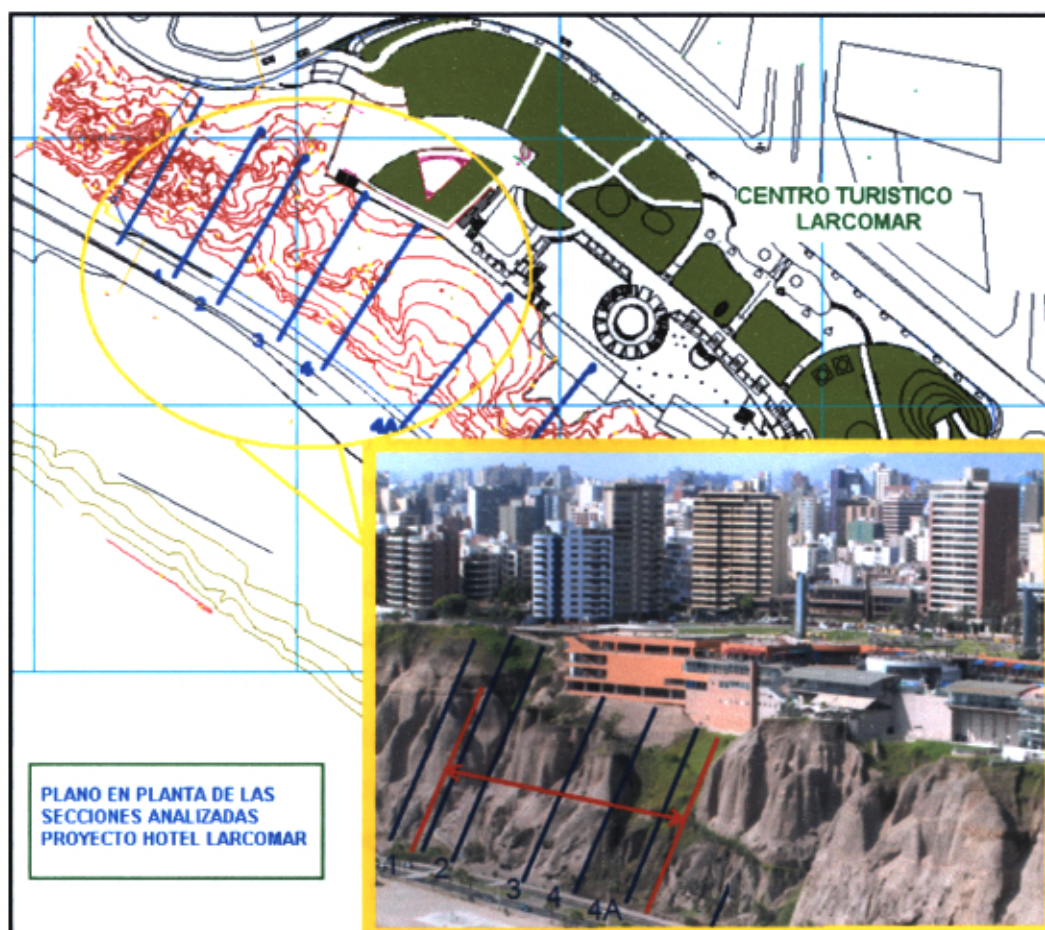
Vista en planta de secciones analizadas para la estabilidad de taludes.
